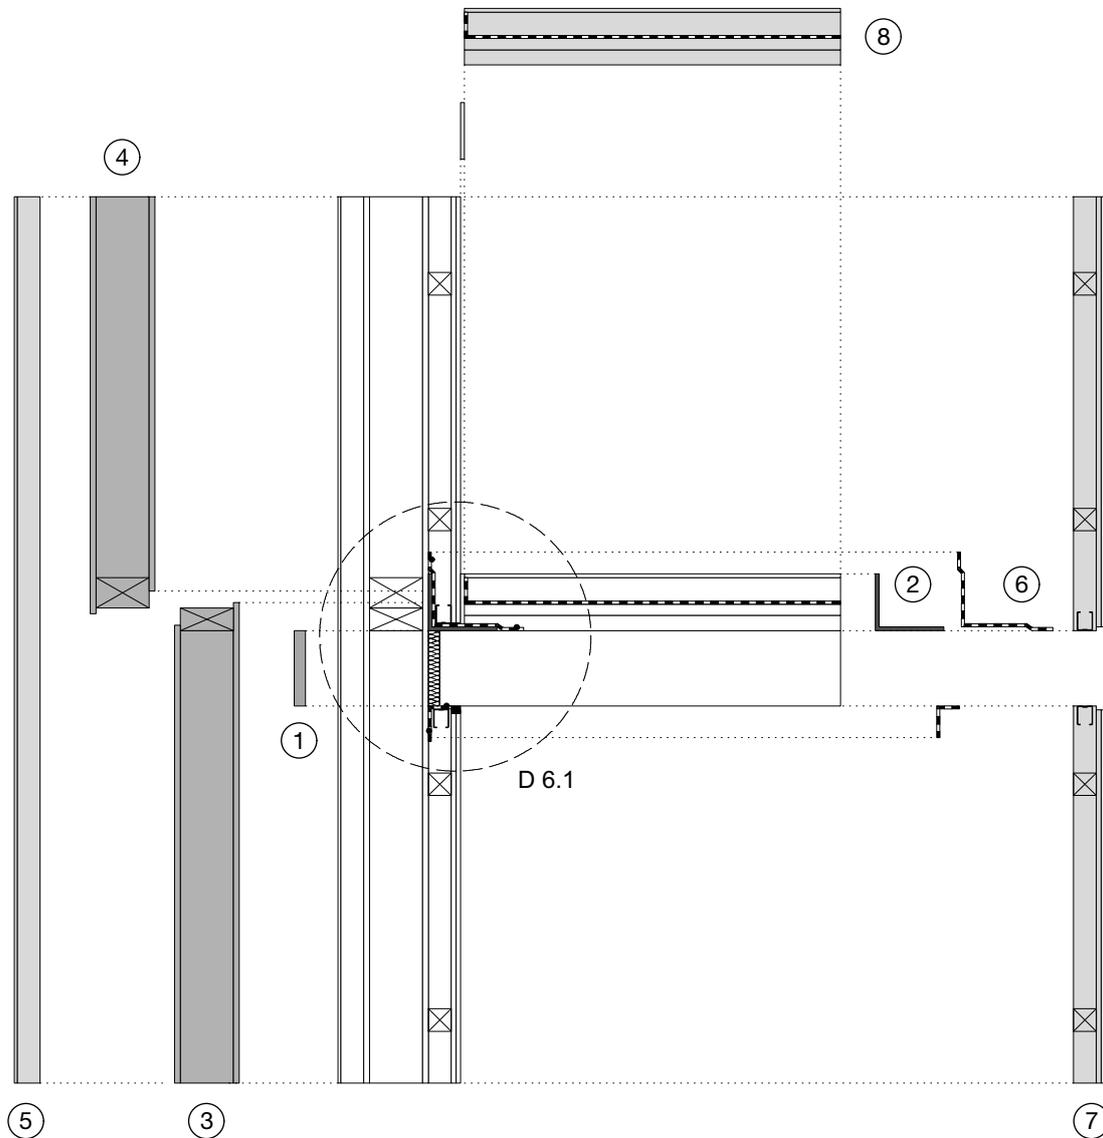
Montagereihenfolge - Anschluss Geschossdecke - Außenwand, vorgestellt
